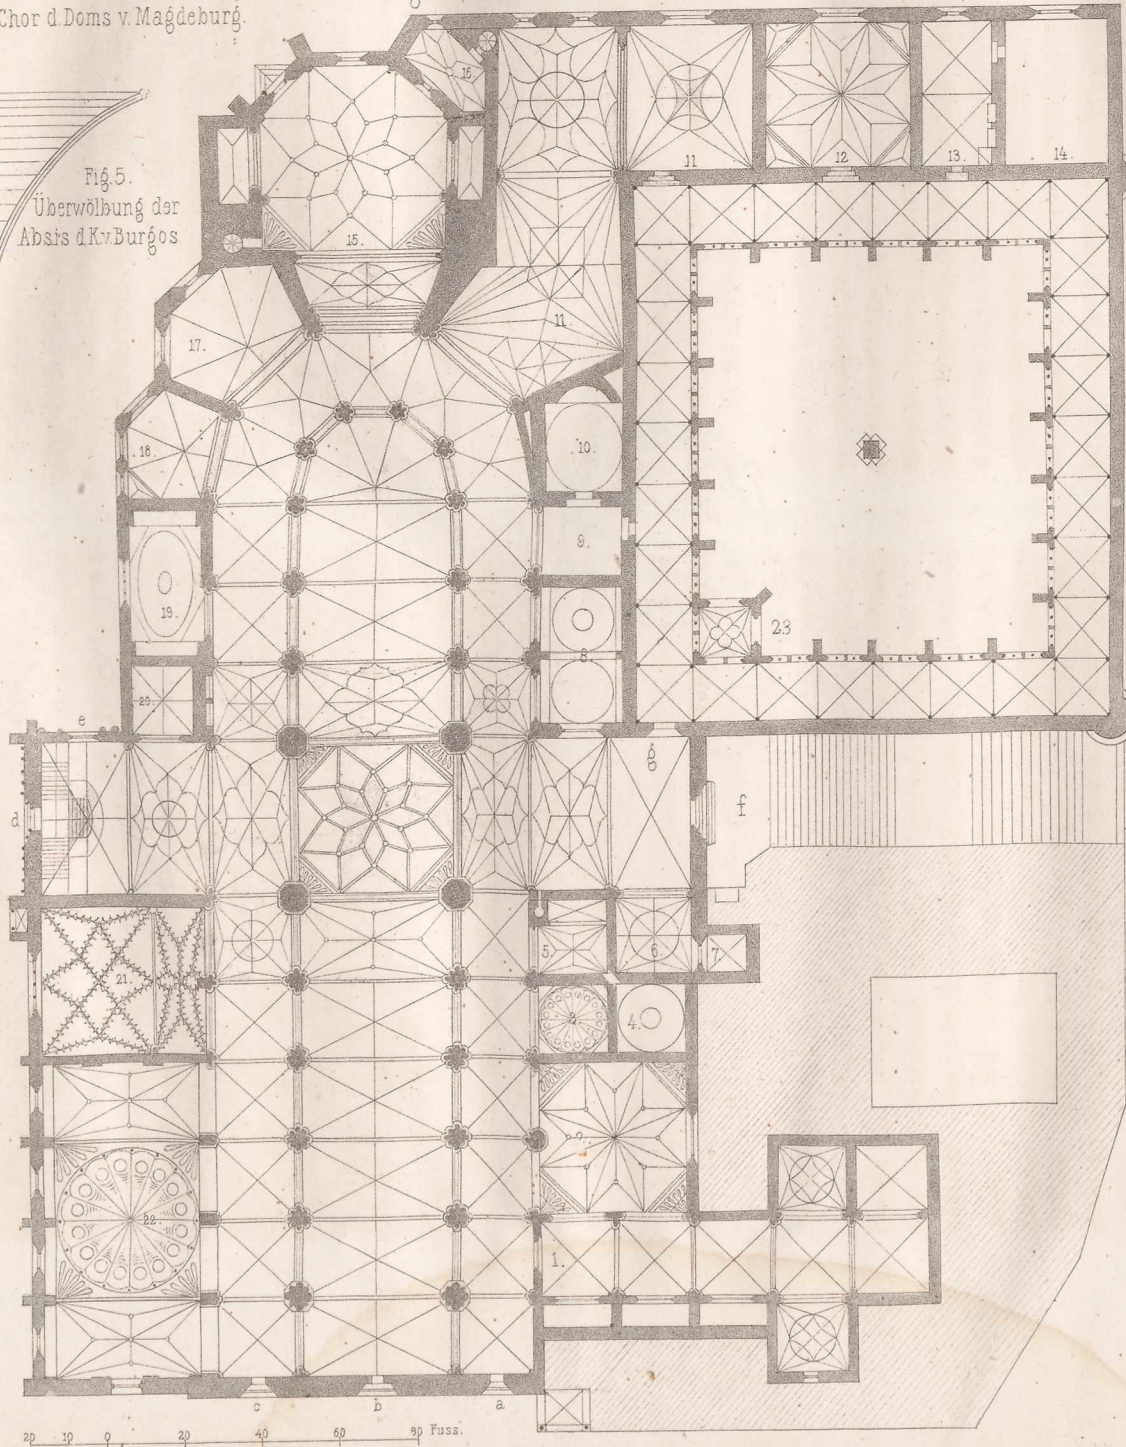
Grundriss der Kathedrale von Burgos.
